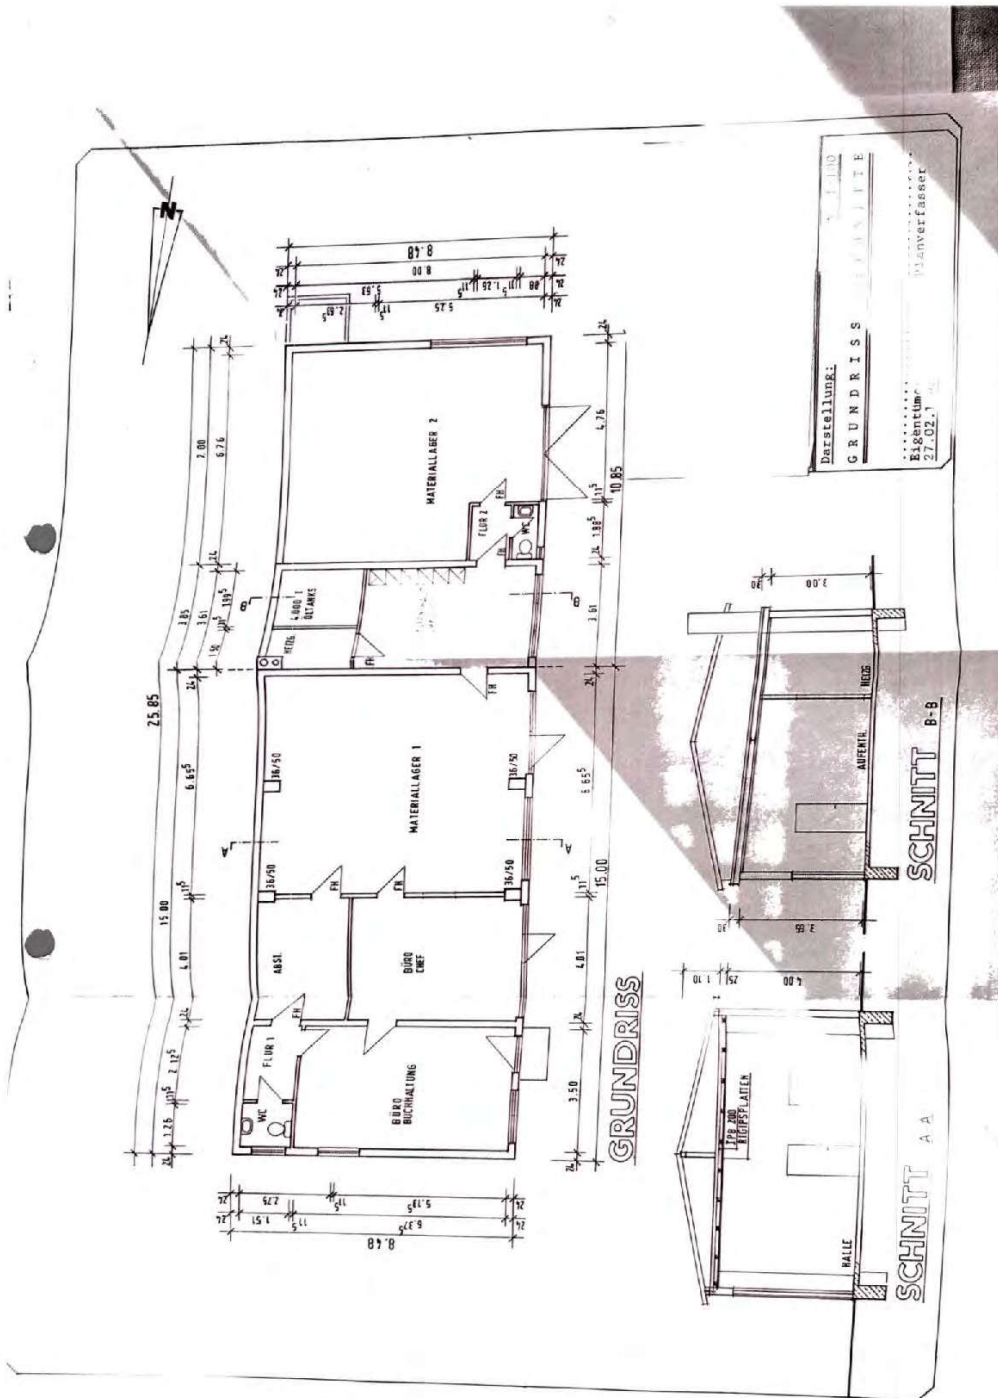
Werkstattgebäude Grundriss / Querschnitte
